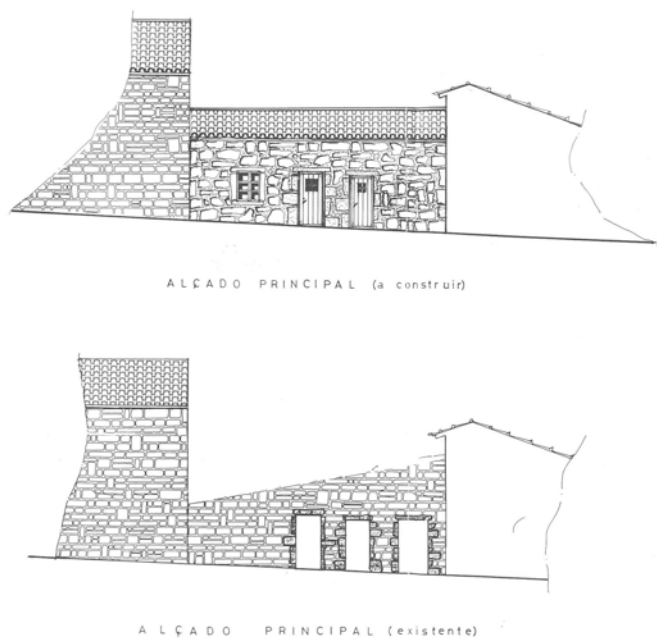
Peças desenhadas do alçado Nascente, projecto de reabilitação do estabelecimento de restauração e bebidas (Ilustração adaptada a partir de Portugal, 2001b, p. 5).
